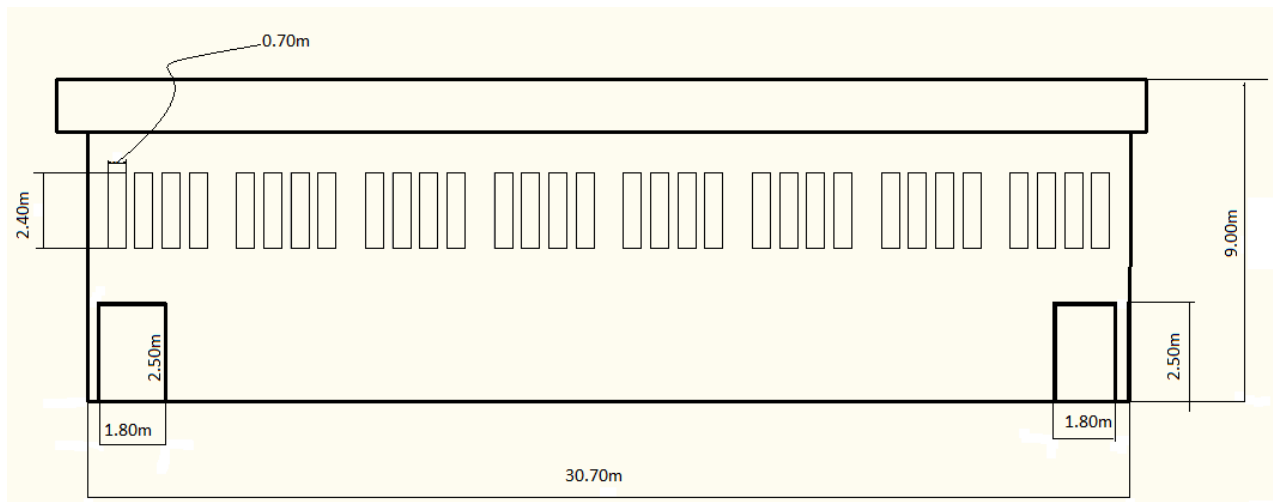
Surfaces des ouvertures sur la façade latérale gauche
